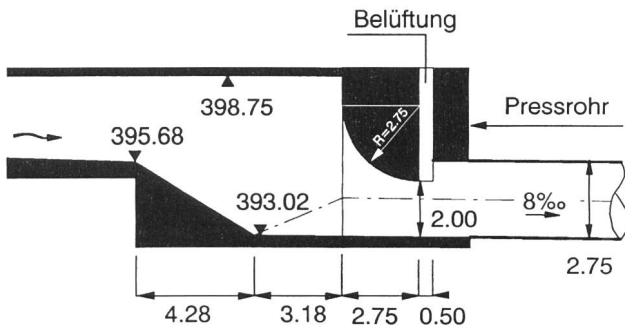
Detail Stolleneinlauf mit Ausrundung und Belüftungsschacht, um das Zuschlagen des Hochwasserentlastungsstollens zu vermeiden, Längsschnitt. Masse in [m].
